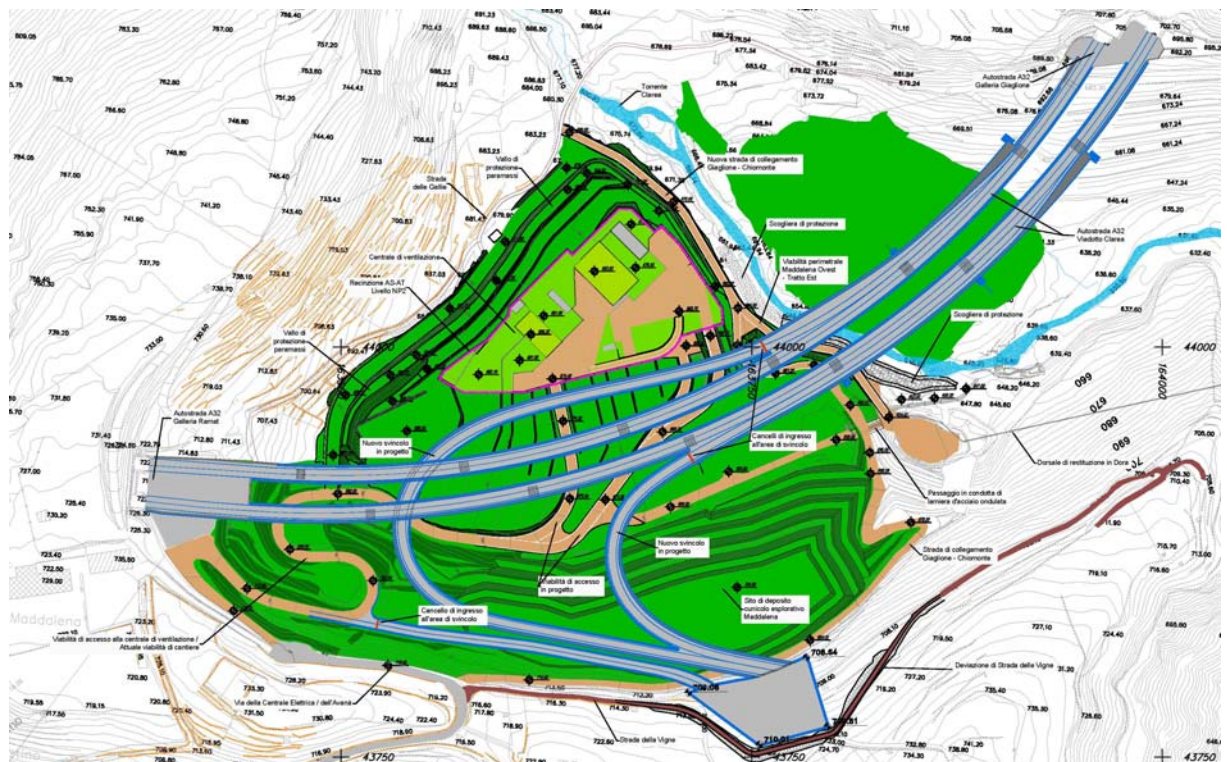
Rilevato paramassi – planimetria di sintesi con sistemazioni esterne
